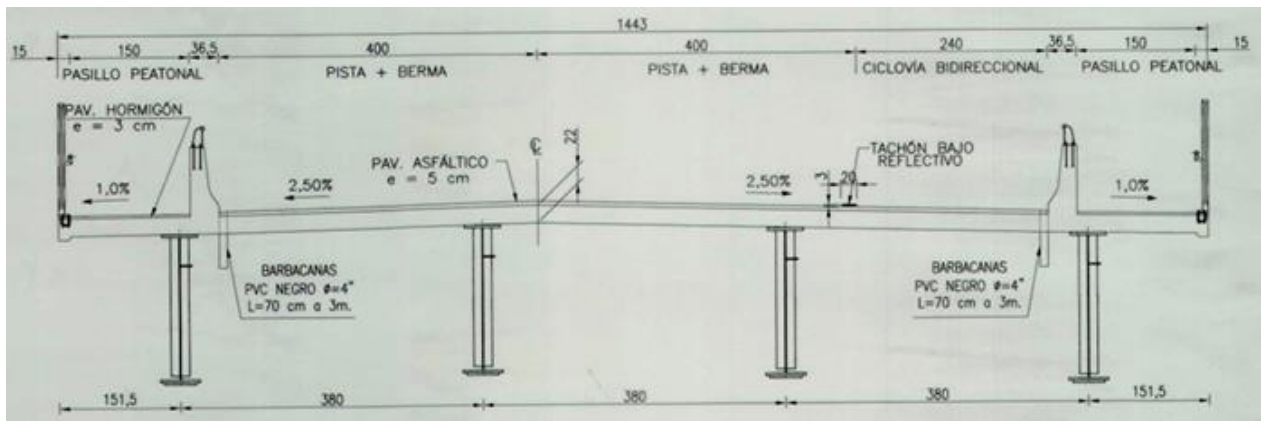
Plano sección transversal típica tablero Puente Marquesa.
